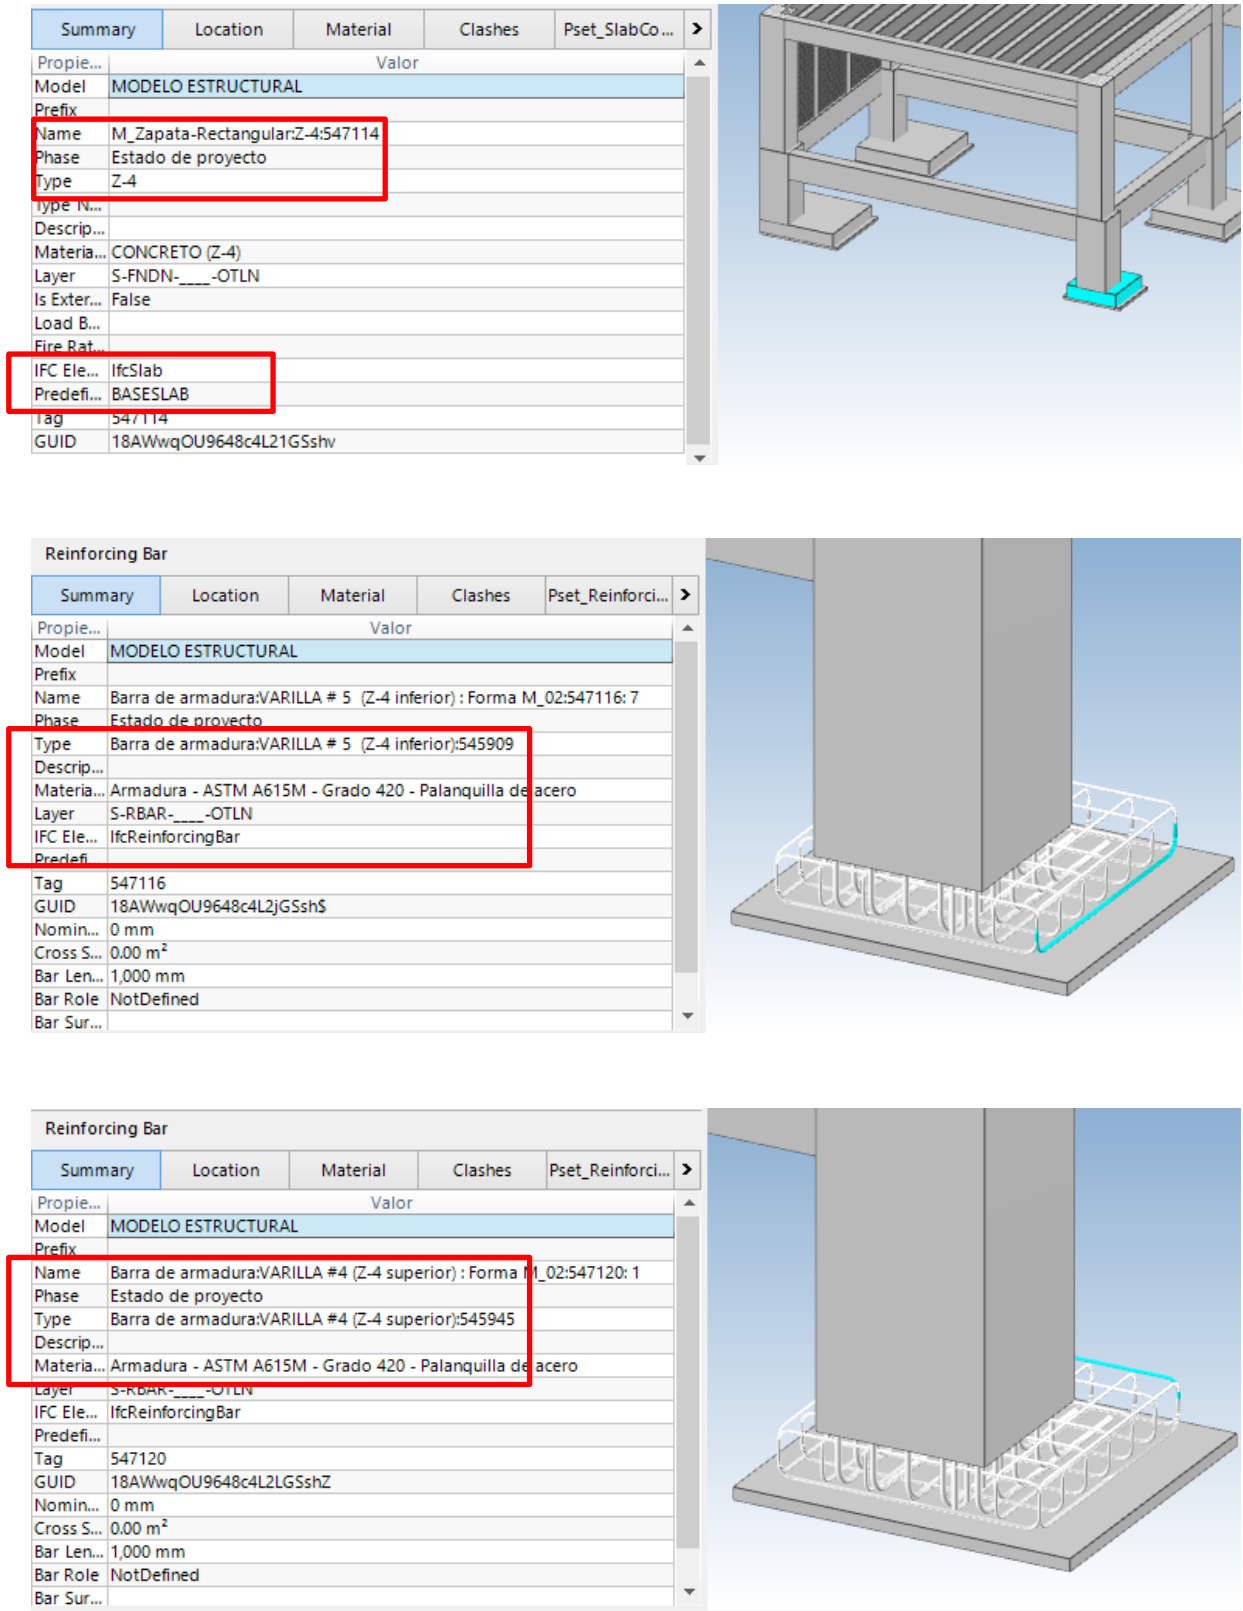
Zapata Z-4, archivo IFC - BIM Collab (Autoría propia).
